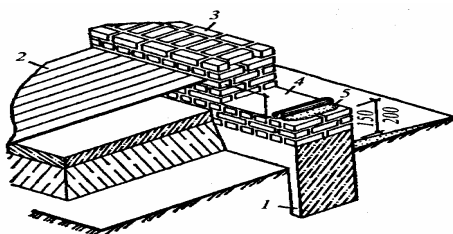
Горизонтальная гидроизоляция стены бесподвальных зданий:
